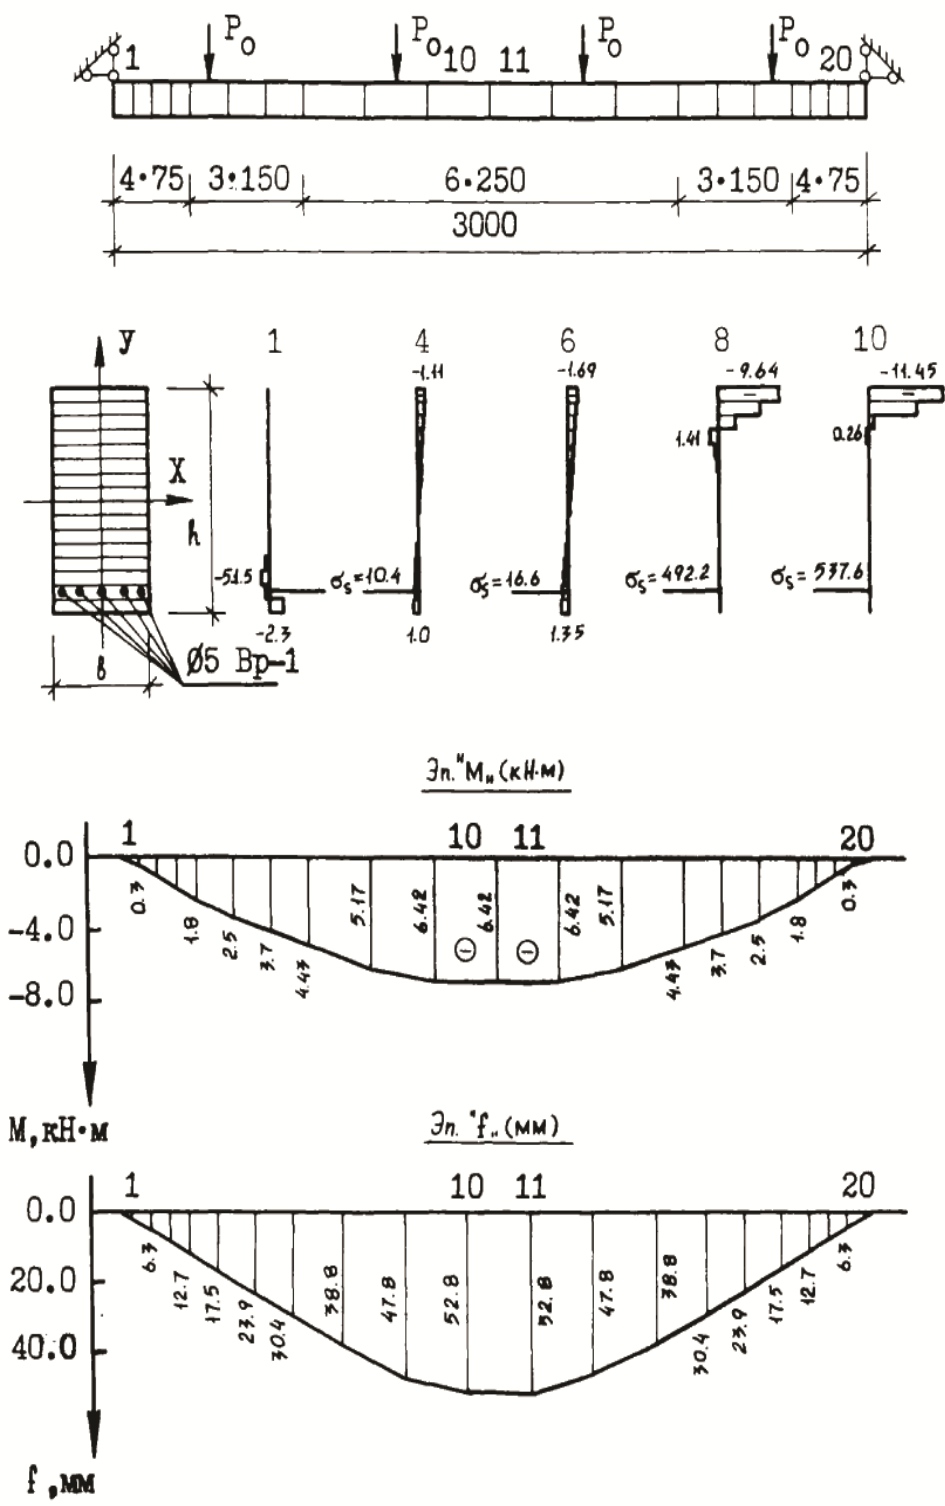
Эпюры напряжений, моментов и прогибов сборных железобетонных плит перекрытий ($e=h/2$ и $P_0=5.0$ кН)
